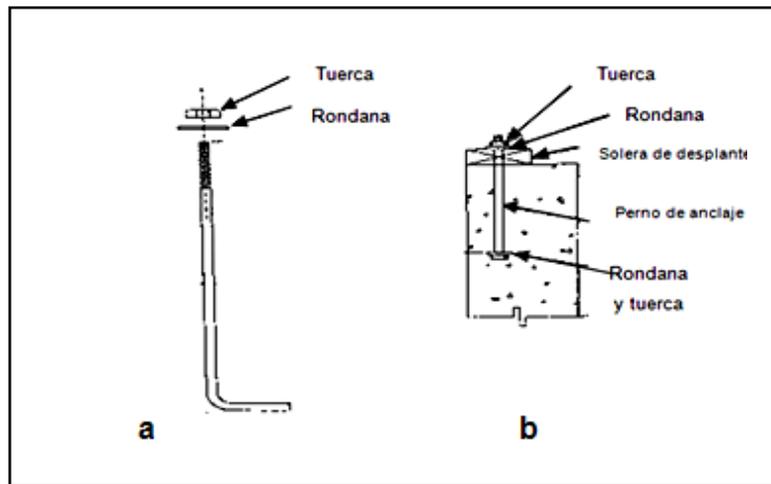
a) Ancla para fijar la losa de concreto con la cadena de sobrecimiento; b) Perno integrado a la cadena de cemento para fijar la solera de desplante.
